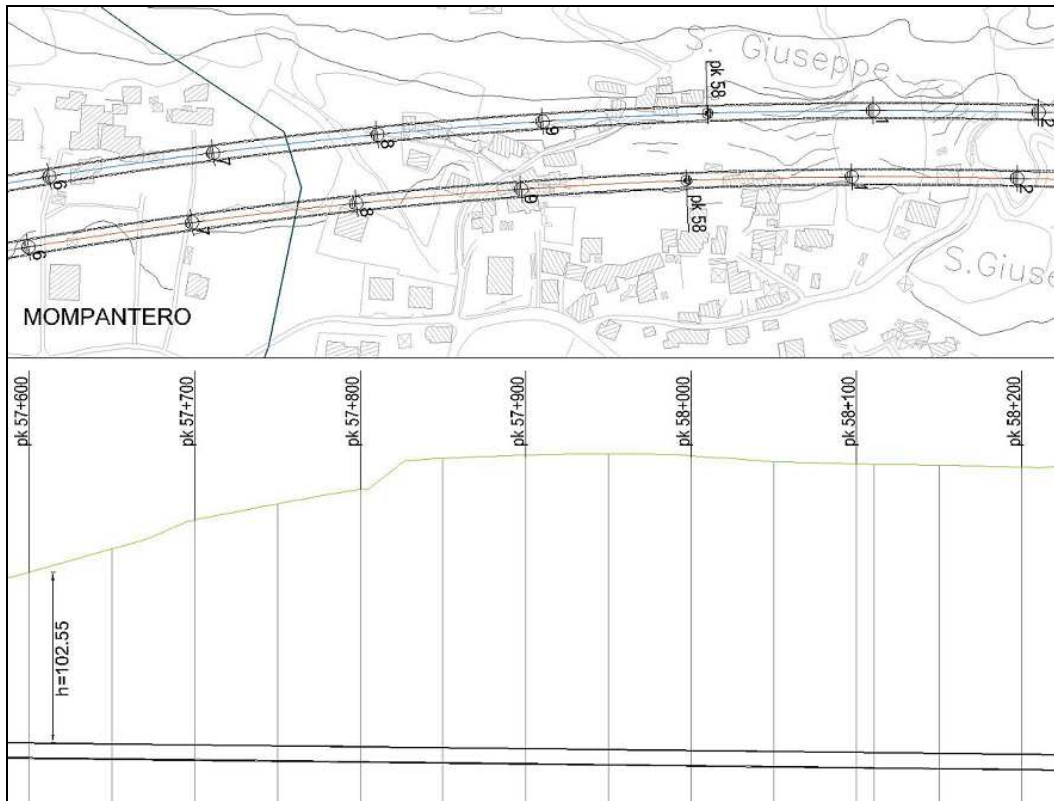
Stralcio Sottoattraversamento Mompantero - Planimetria + Profili 1d13
